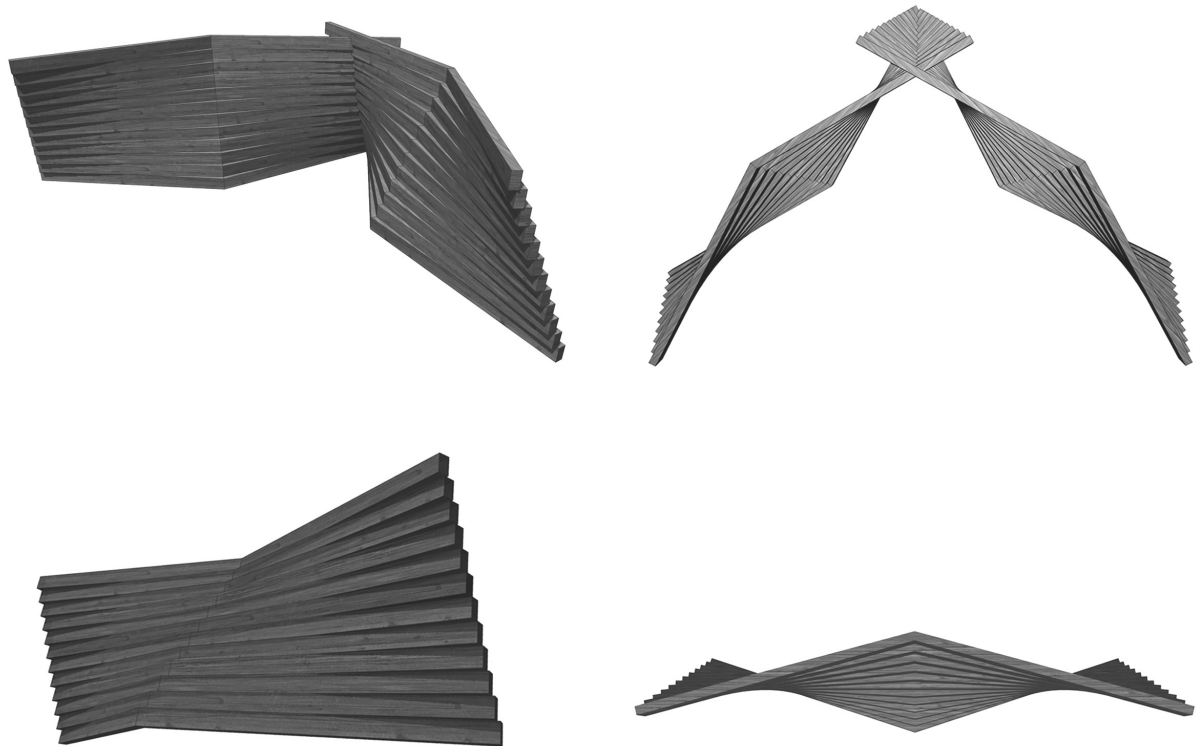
Studie zu verdrehten Blockbauflächen (Perspektiven links, Grundrisse rechts)
